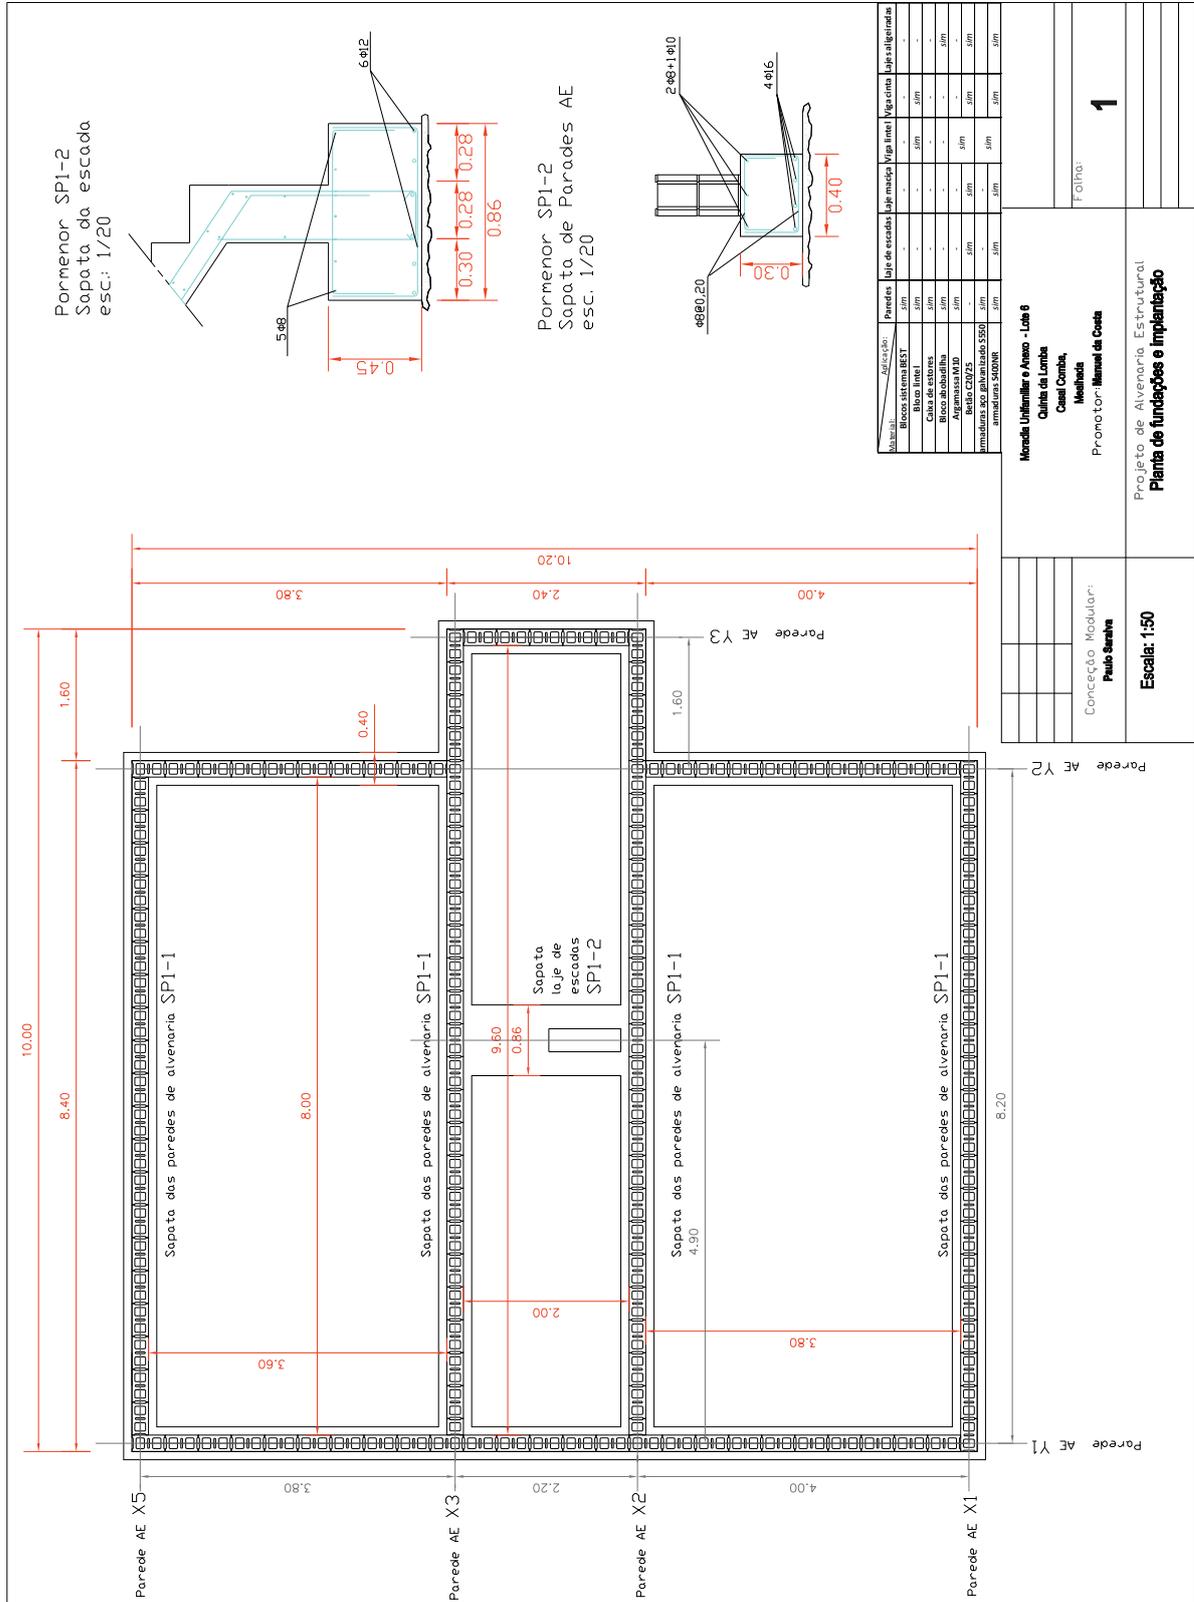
Planta de fundações com a incorporação da 1ª fiada da solução em AE
